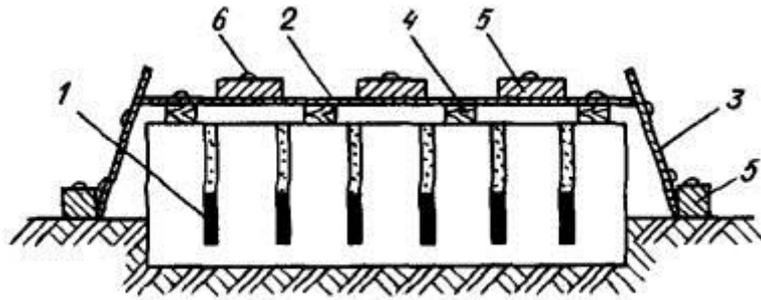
Установка сплошного щитового укрытия на фундаменте:
